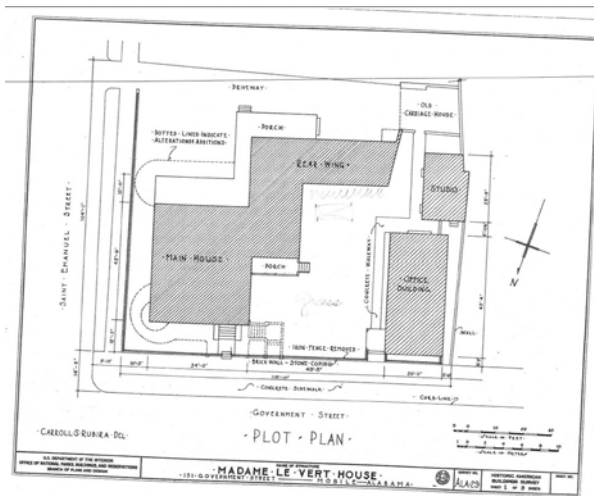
Fred W. Clarke: Madame Le Vert House, in: U.S. Department of the Interior Office of National Parks, Buildings, and Reservations, Branch of Plans and Design, Survey No. ALA-29, n.d.
